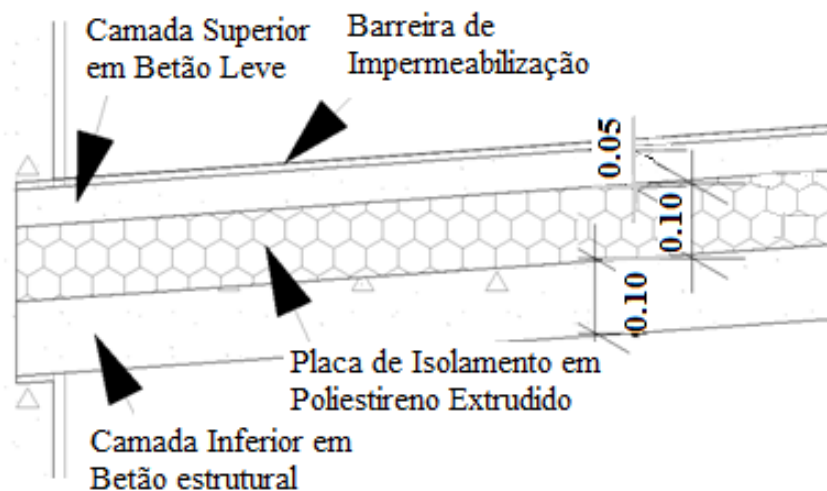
Pormenor da seção tipo do Pannel de Cobertura.
